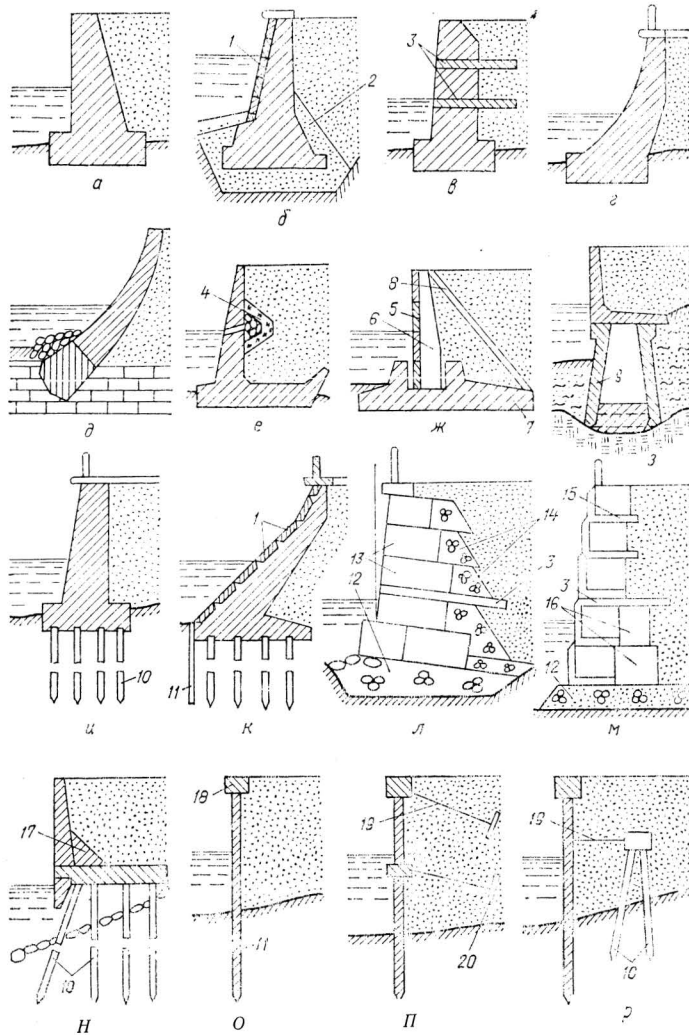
Бетонные и железобетонные подпорные стены набережных:
